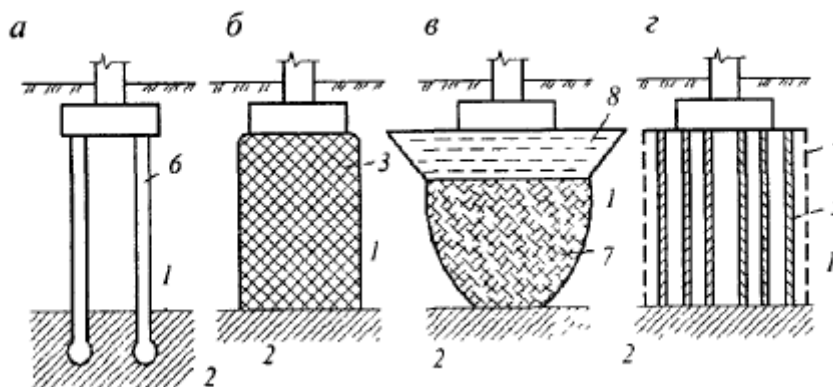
5 Различные варианты устройства оснований и фундаментов в грунтовых условиях при II типе просадочности: 1 -просадочный грунт; 2 - непросадочный фунт; 3 закрепленный грунт; 4 - зона уплотнения грунта грунтовыми сваями; 5 - грунтовые сваи; 6 - сваи; 7 - уплотненный грунт; 8 - грунт, уплотненный тяжелыми трамбовками
